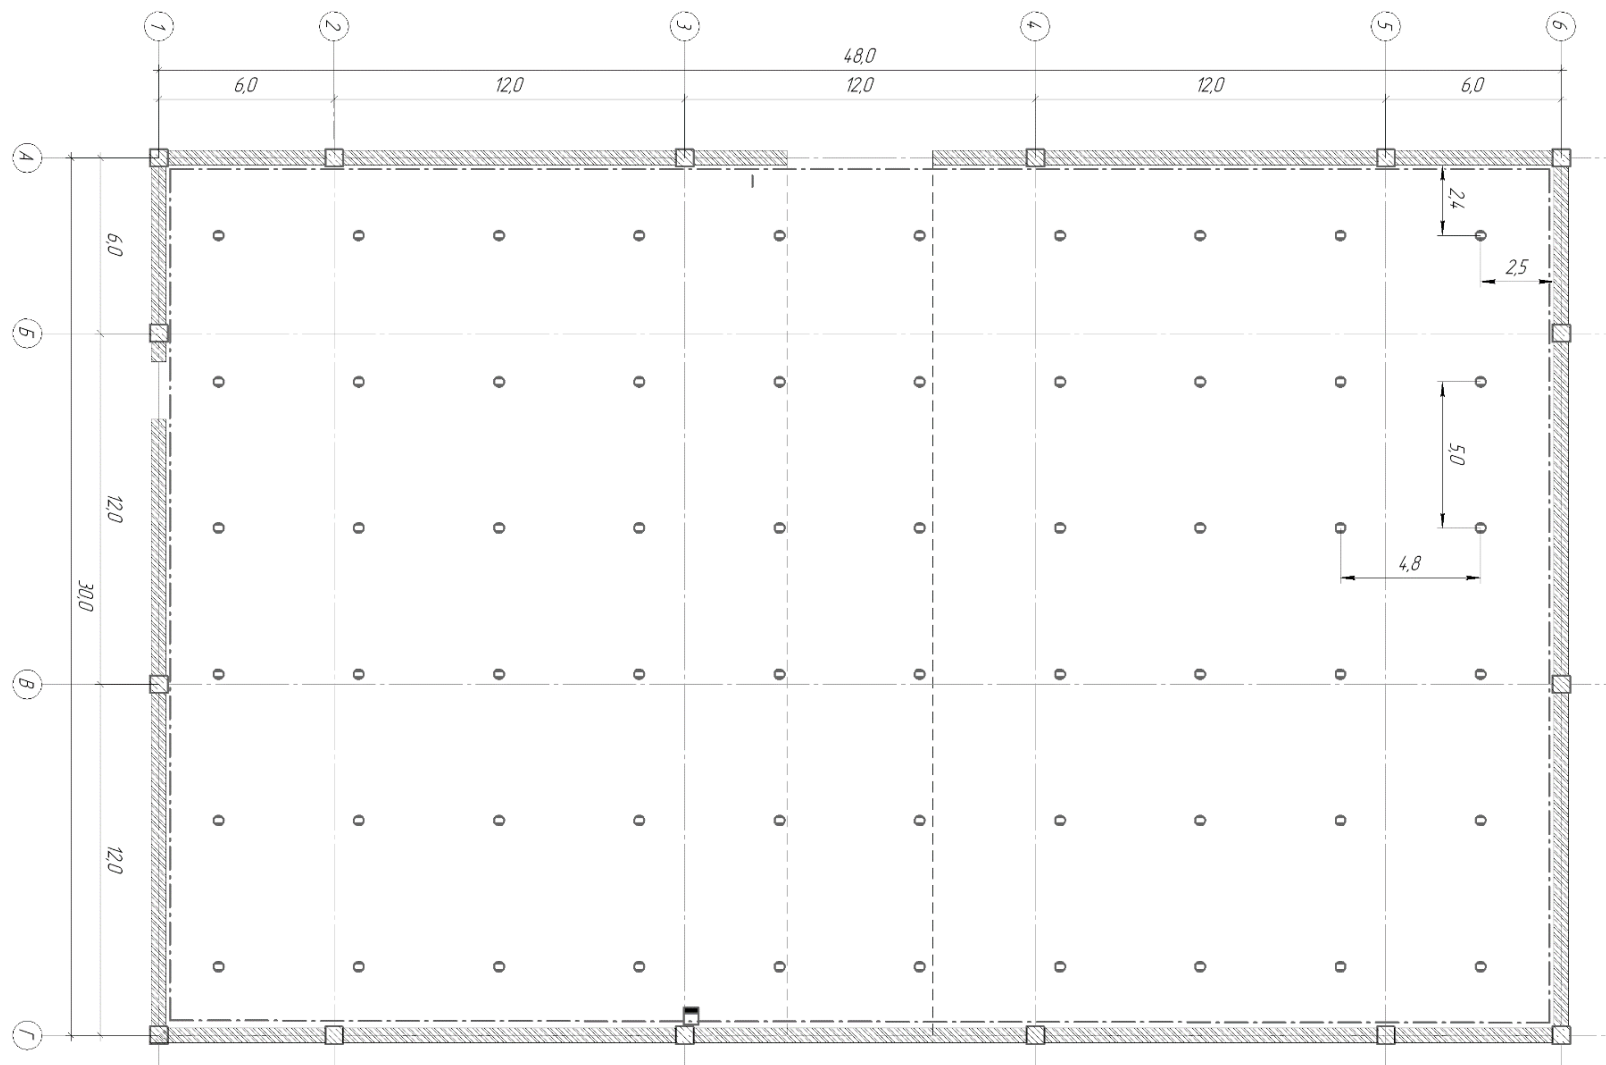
План расположения светильников сборочно-прессового цеха
